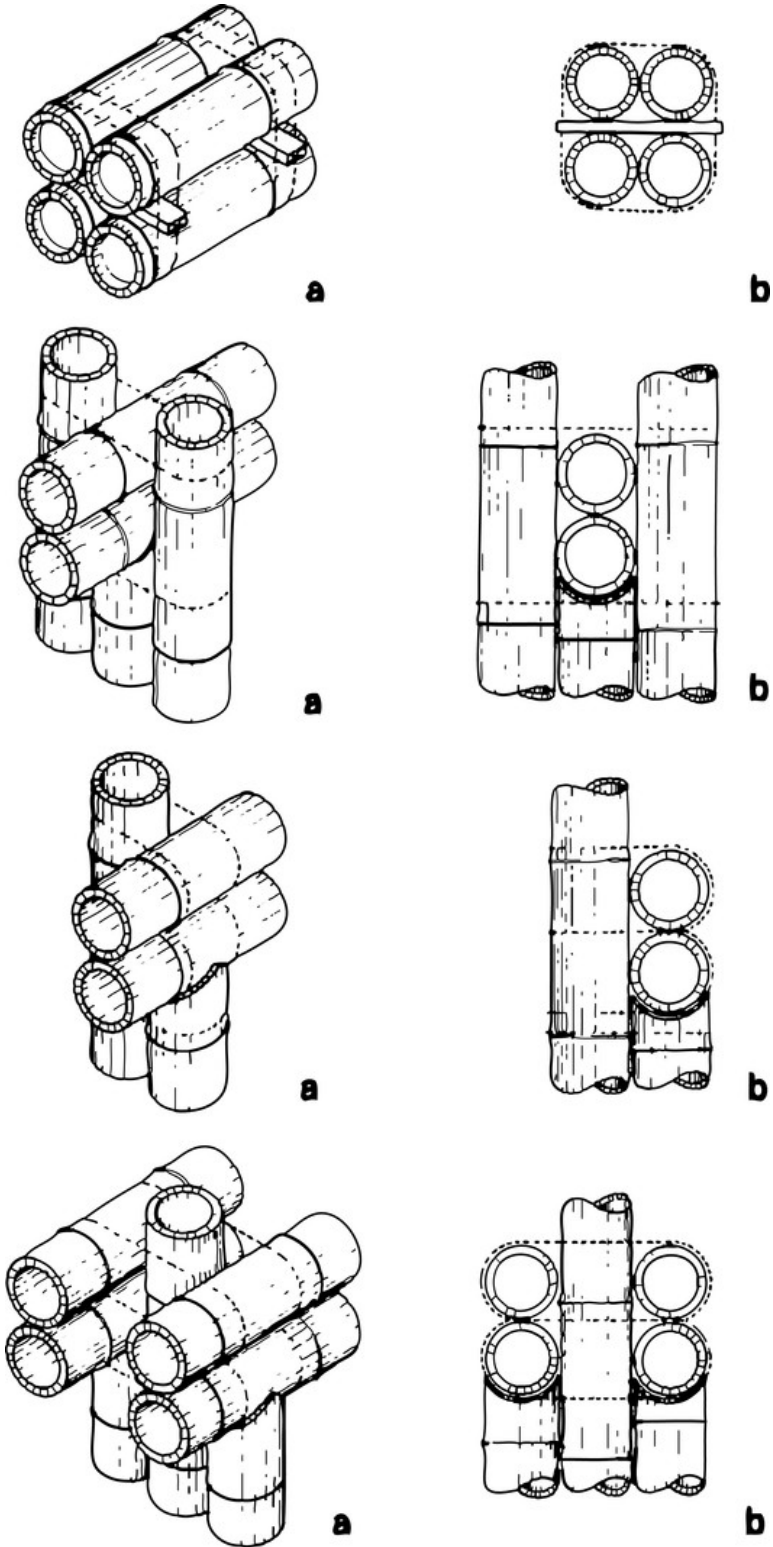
Viga de cuatro elementos, doble viga Central, doble viga lateral, vigas dobles laterales.
